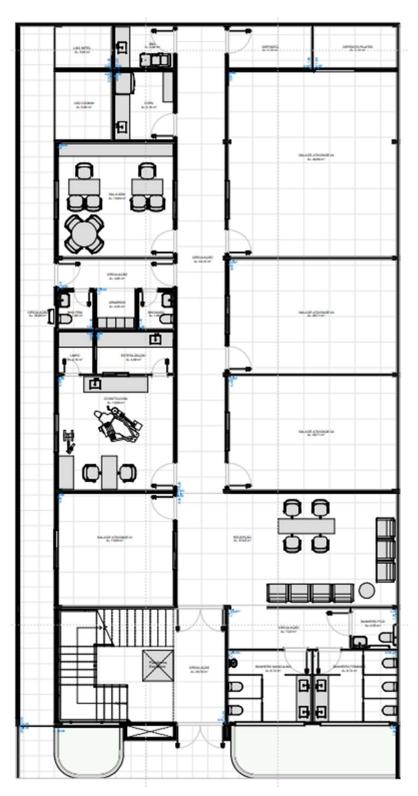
Novo layout SINDCOMERCIO, pavimento térreo, Redenção/PA.
